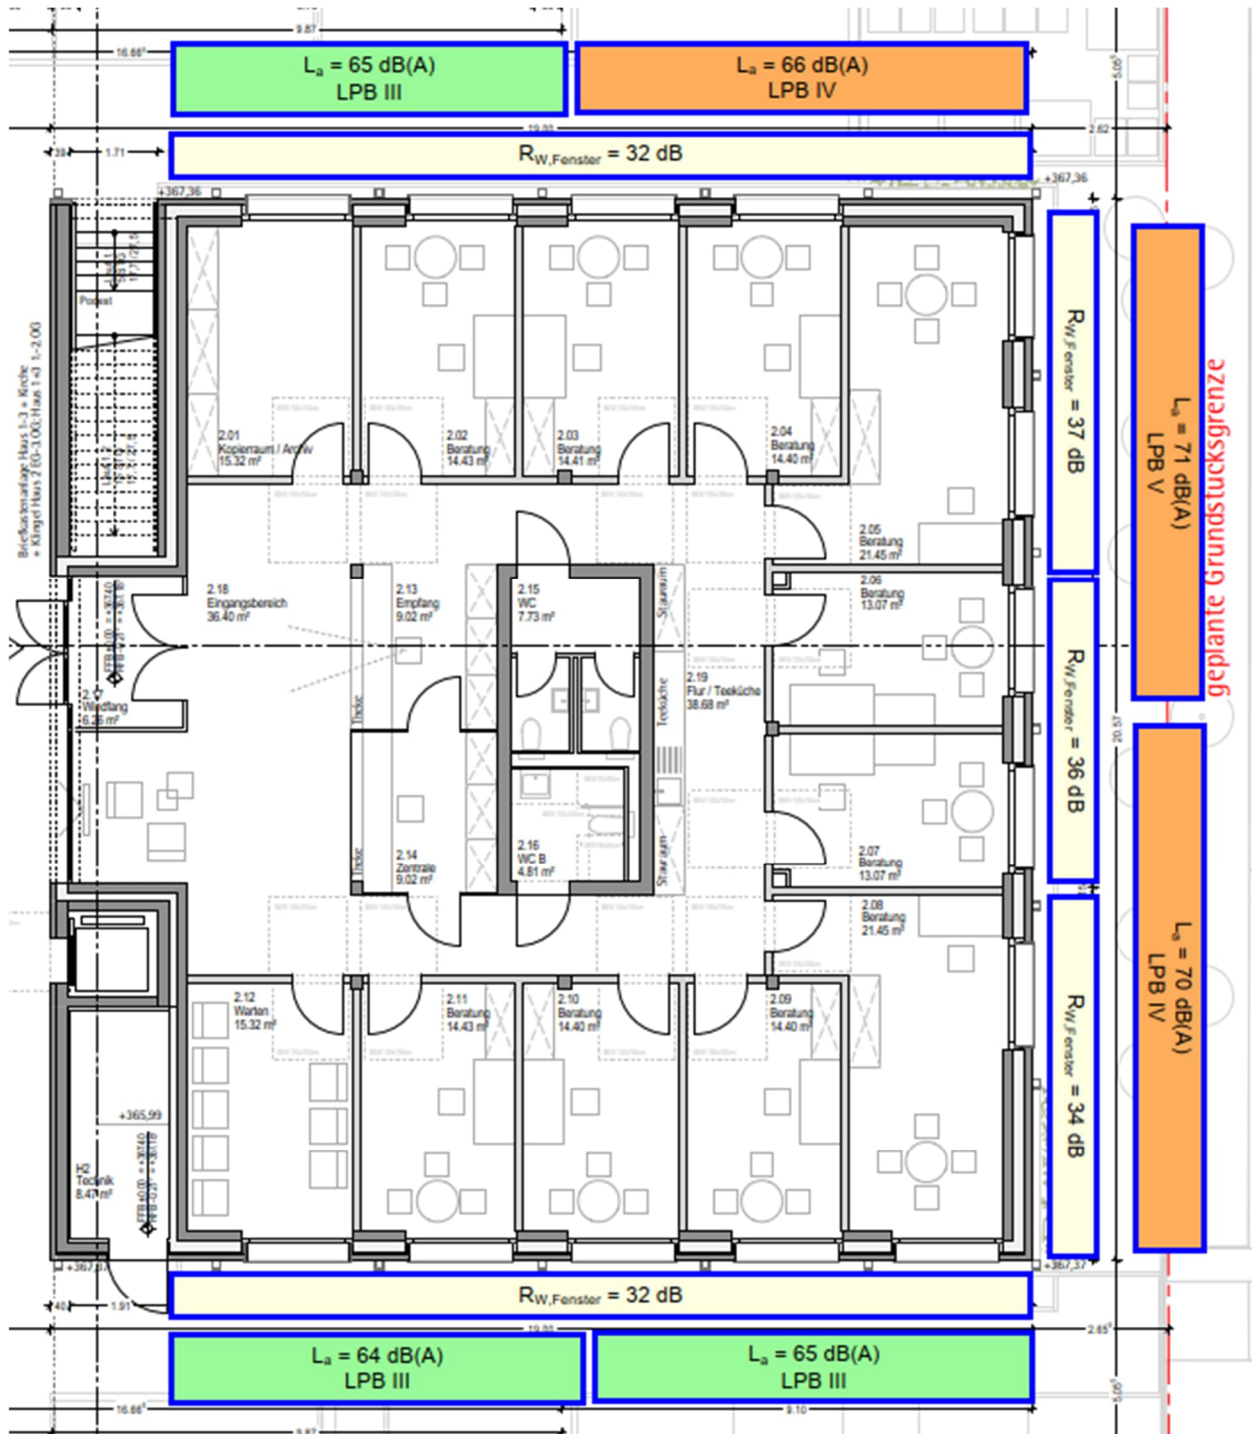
Außenlärm – Grundriss 2.OG – Haus 1
